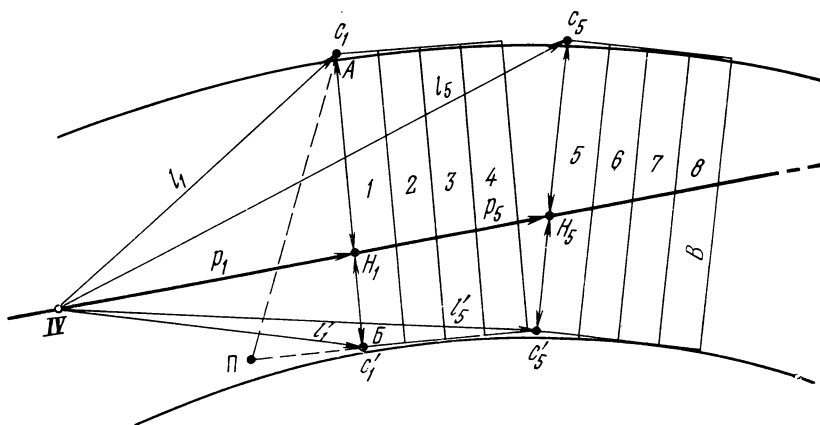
К определению размеров скобок для сборной железобетонной крепи
